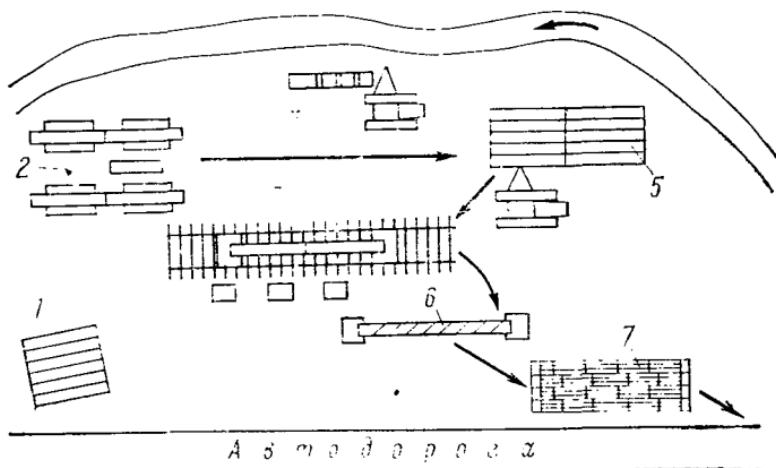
Схема трубозаготовительной базы с установкой УИ-141:
